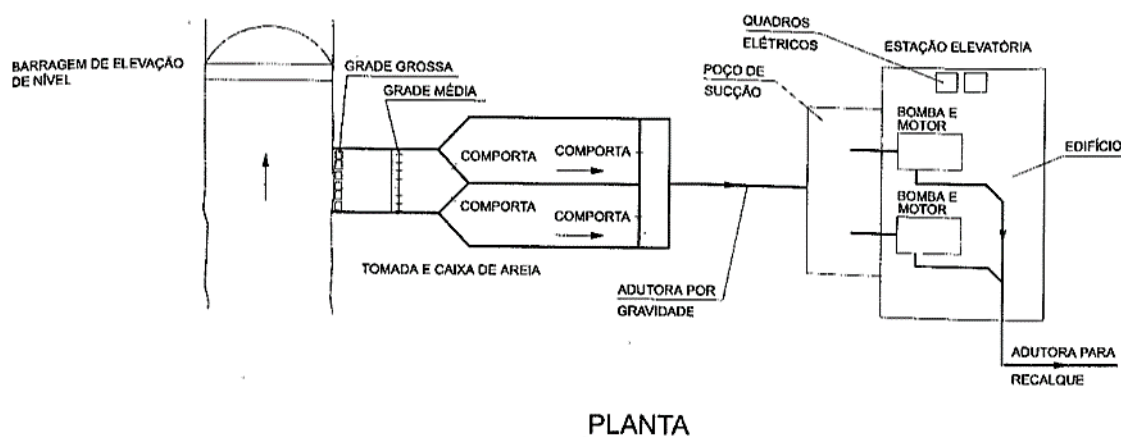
PLANTA DE UMA TÍPICA CAPTAÇÃO EM CURSO D'ÁGUA.
